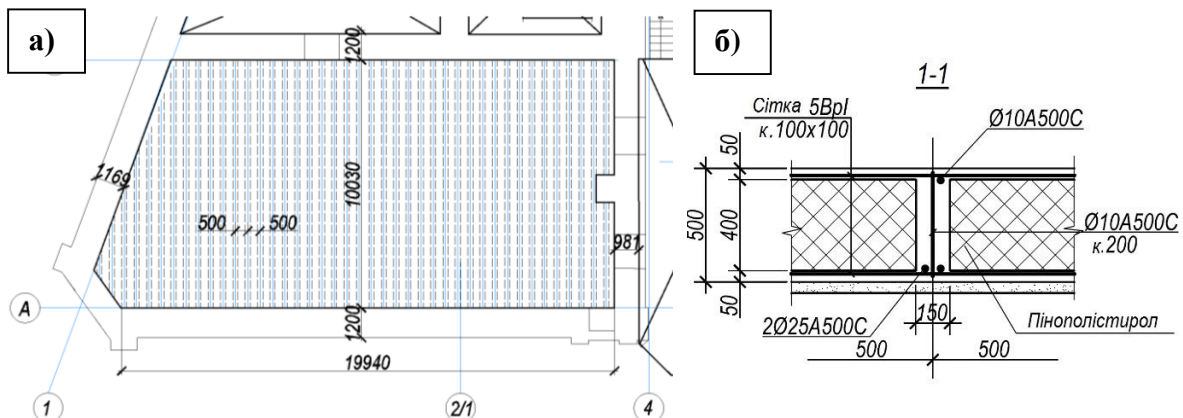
Конструктивна схема фрагменту залізобетонної плити перекриття: а) схема розташування ребер; б) поперечний переріз по ребру
